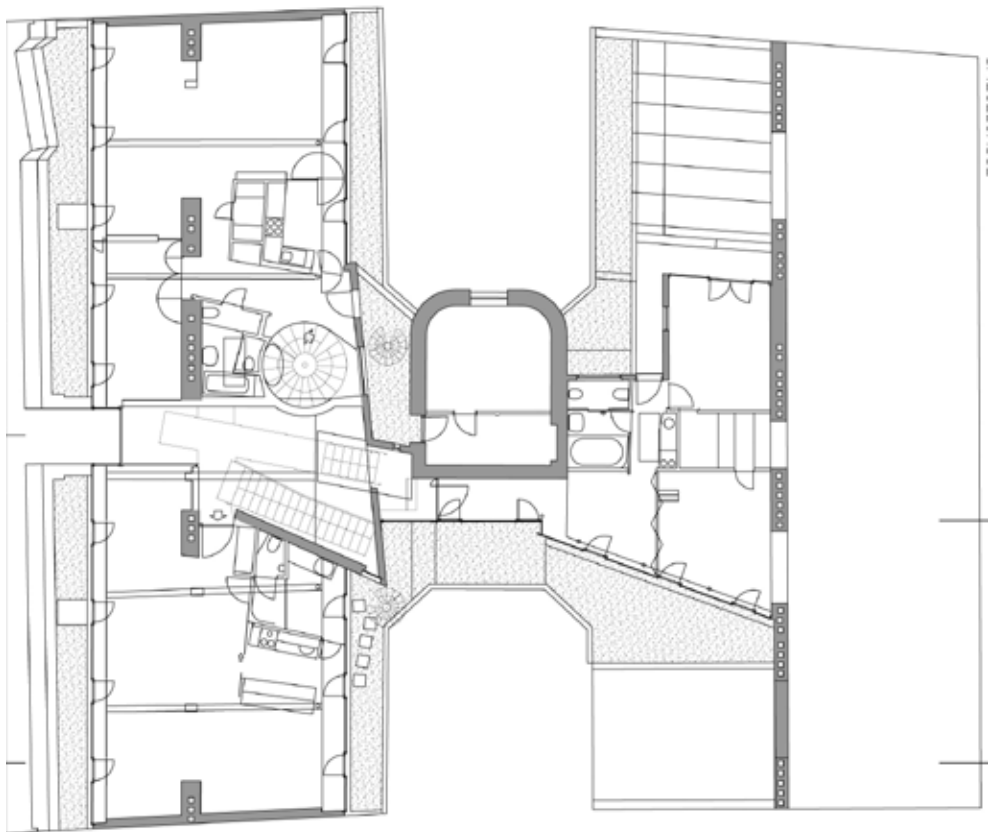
Grundriss 6.OG © Rüdiger Lainer
